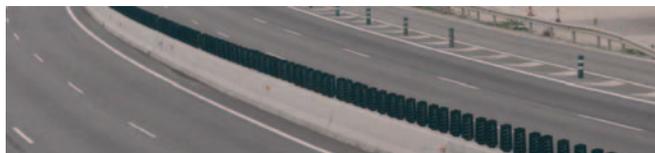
Detalle de Lamas antideslumbrantes, colocadas sobre bionda rígida de hormigón.
